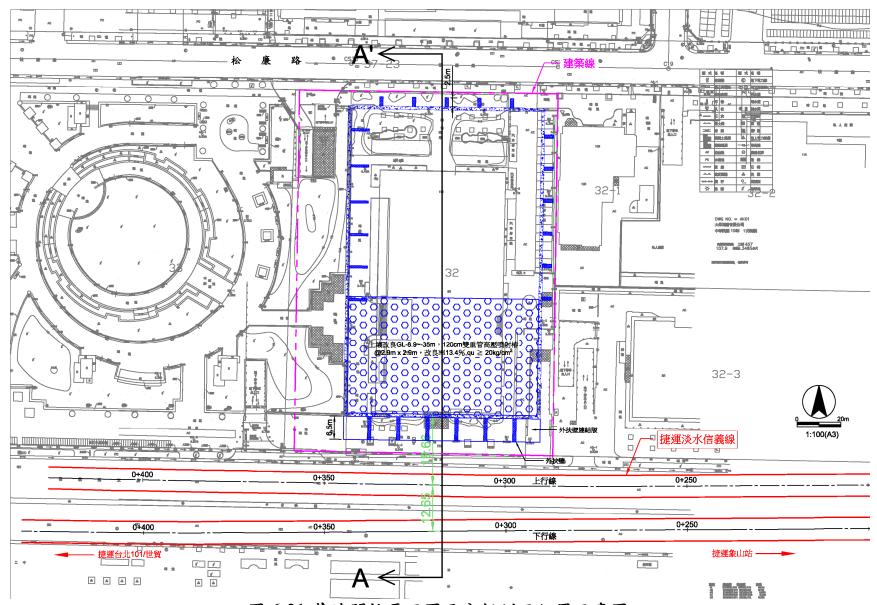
基地開挖平面圖及分析剖面位置示意圖
